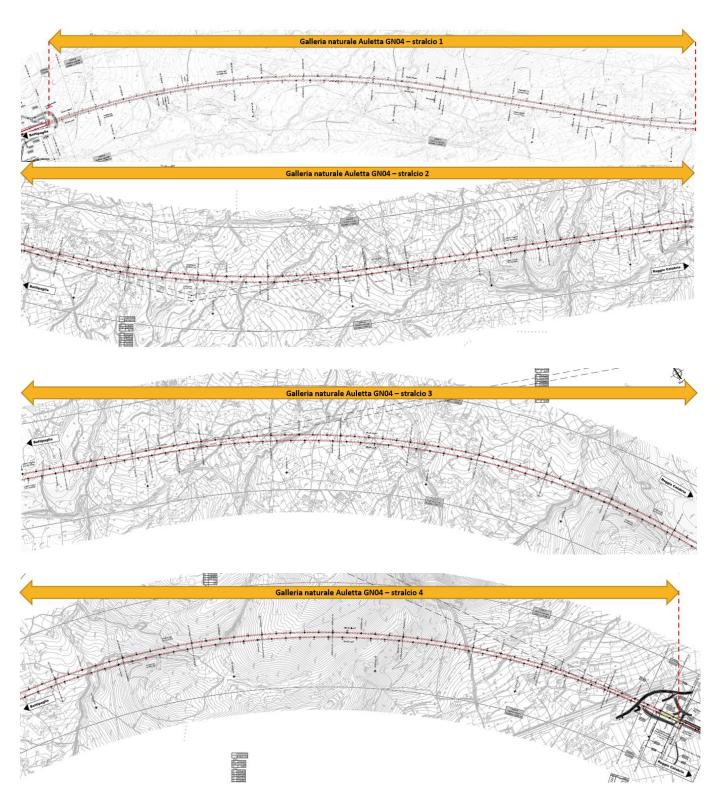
Planimetria galleria naturale GN04 da km 6+188 a km 21+927 BP
